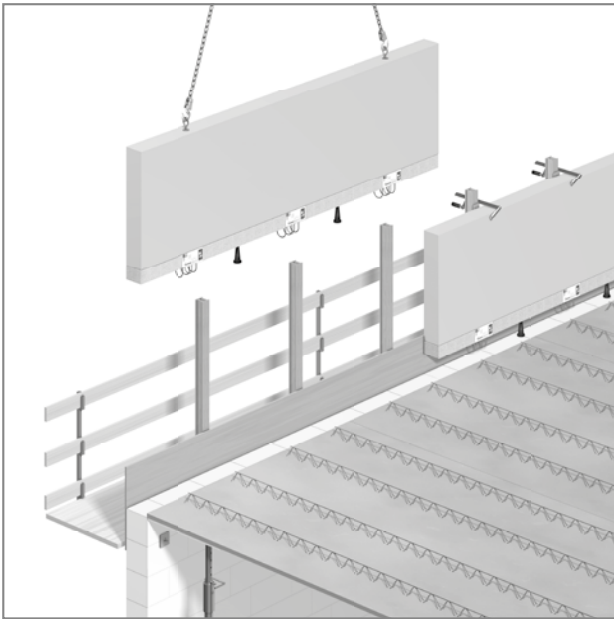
Schöck Isokorb® XT Typ A mit Combar® FT-Montagestütze: Einheben der Fertigteilattika
